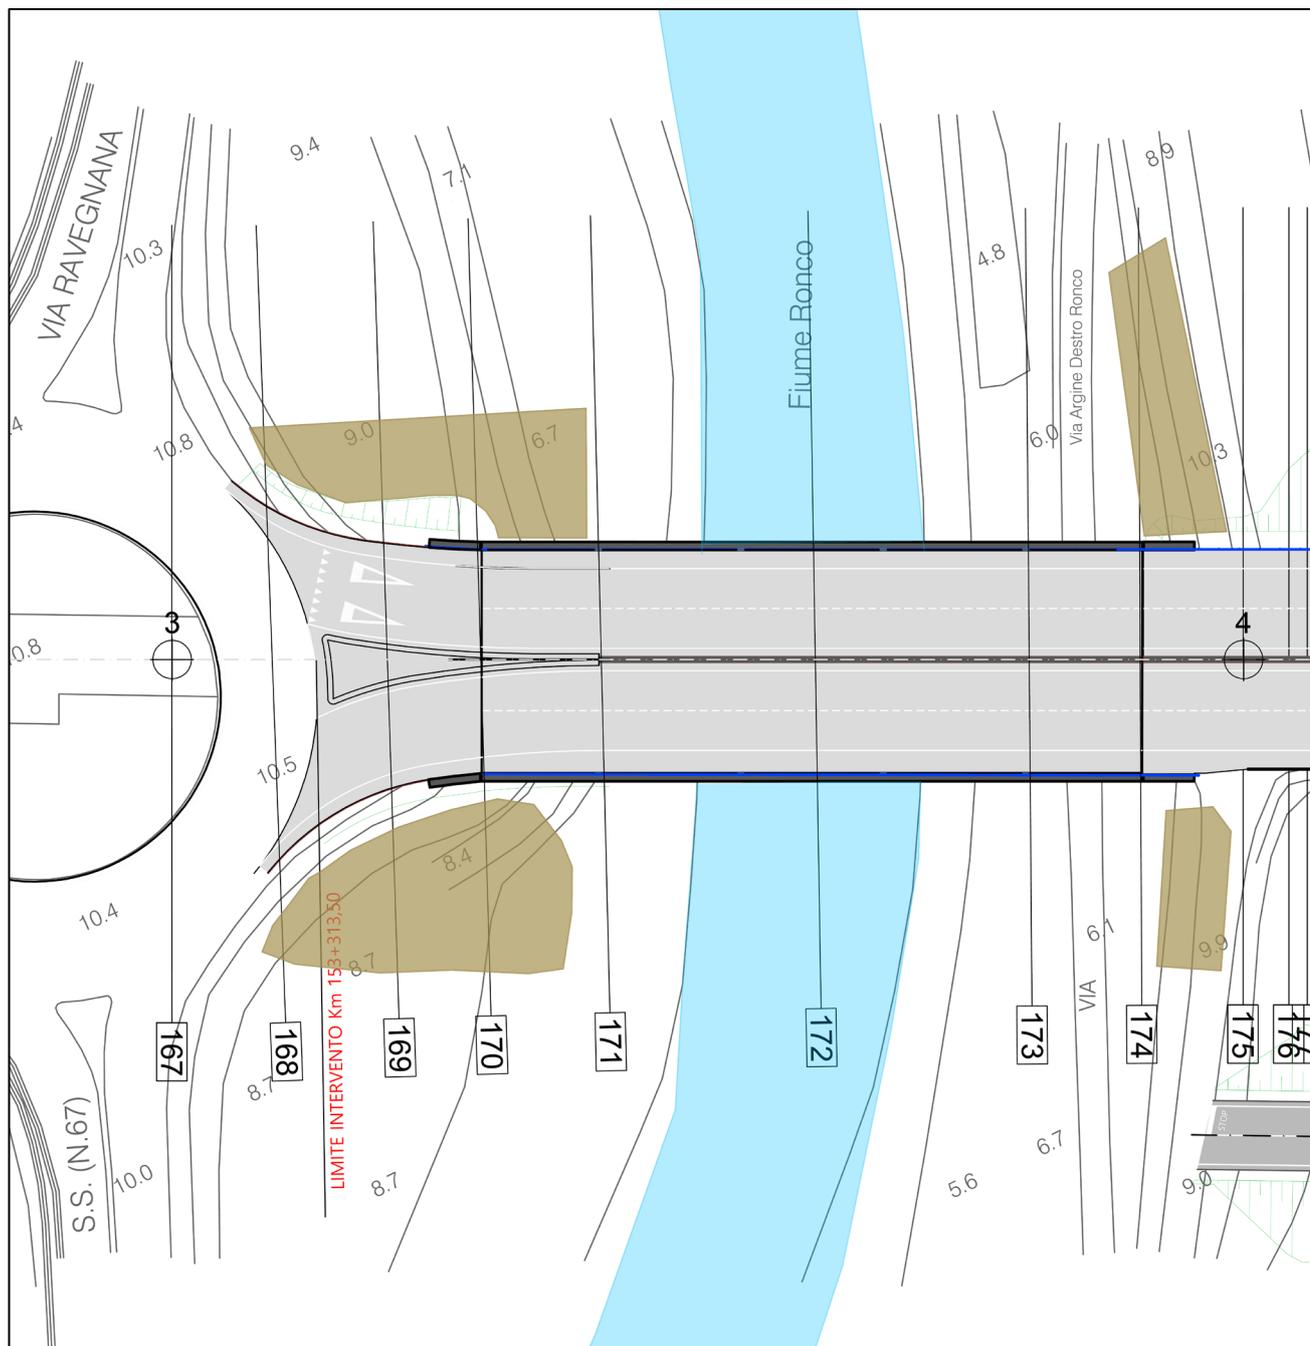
Planimetria Tratto B – 4 Aree di sistemazioni a verde
